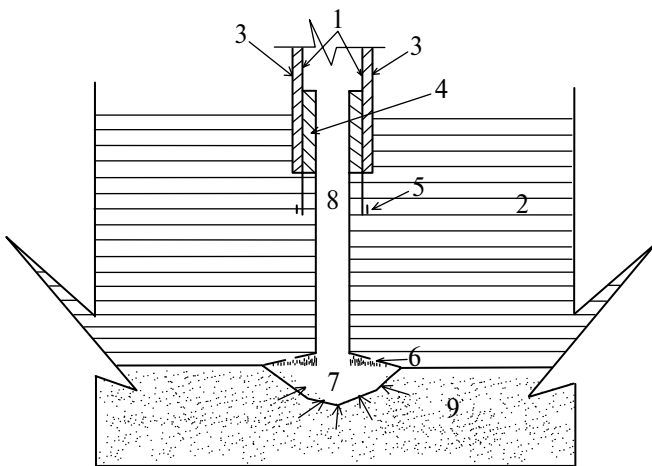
Фрагмент зоны сопряжения башмака эксплуатационной колонны в кровле водоноса бесфильтровой скважины
